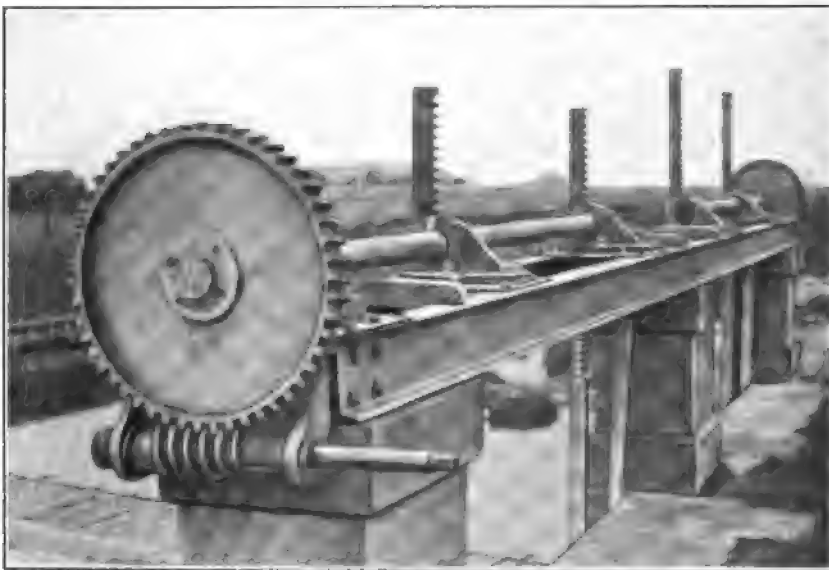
Aufziehvorrichtung an einem Wehre an der Elz.
